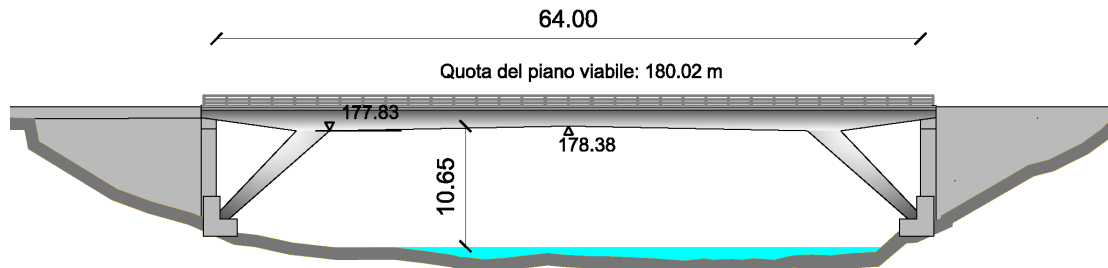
prospetto del nuovo ponte come da soluzione di progetto.
